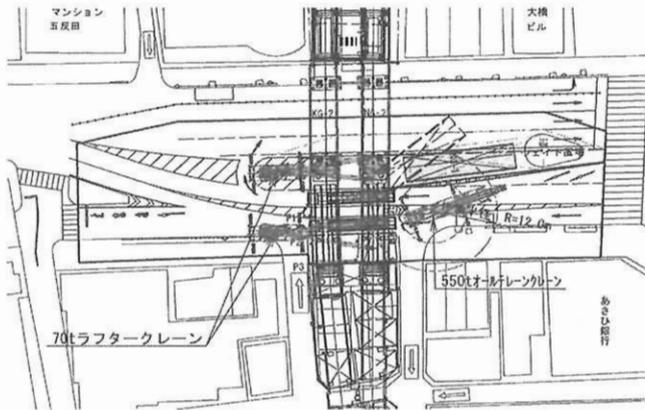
大型 (550 t) クレーンによる一括架設工法計画平面図
